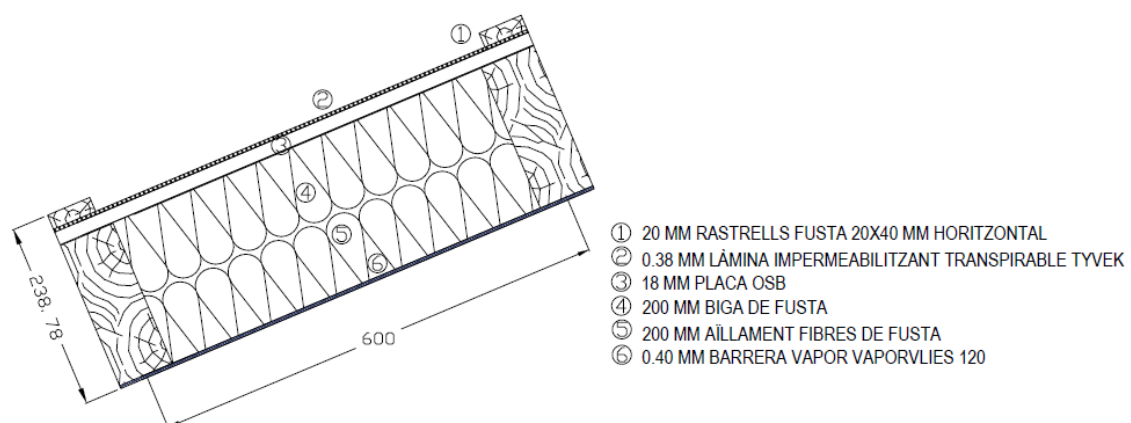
Secció coberta inclinada (sostre planta pis). Font: Pròpia.
